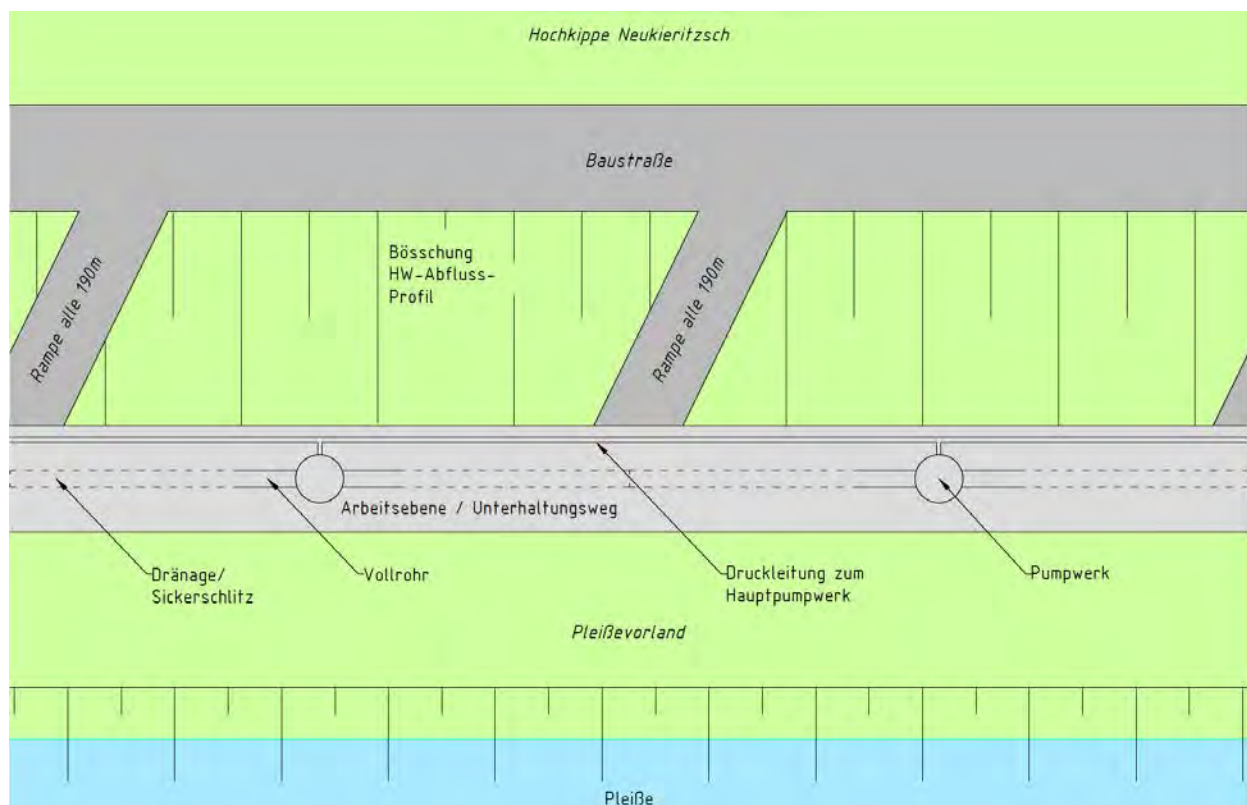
Prinzipskizze Sickerschlitz mit Sammelschächten im Grundriss (gefräst)
